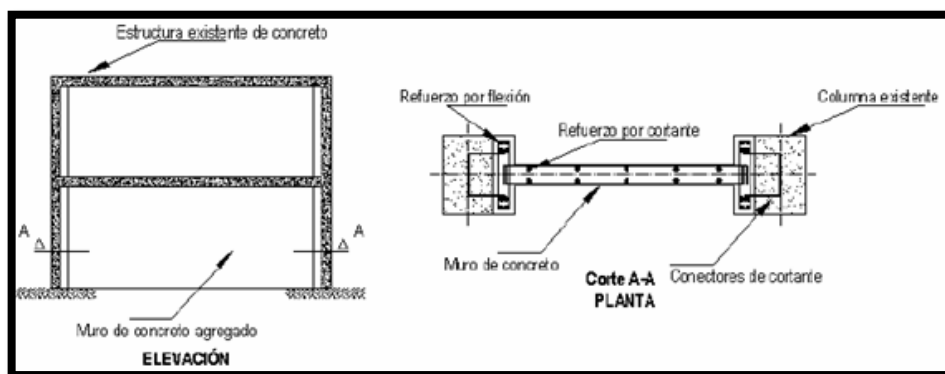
Detalles de muro de concreto (Aguilar,J.; Breña,S.; Del Valle,E.; Iglesias,J.; Picado, M.; James M., 1996)
